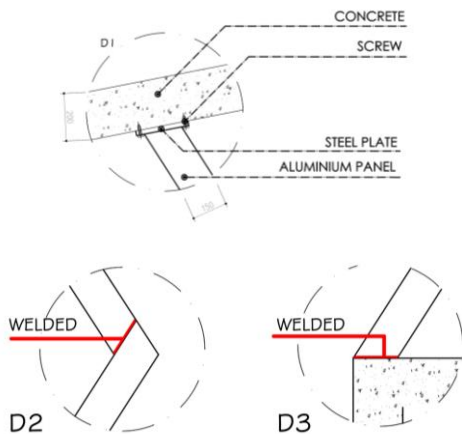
Potongan dan Denah Entrance Kapel. Sumber: penulis
